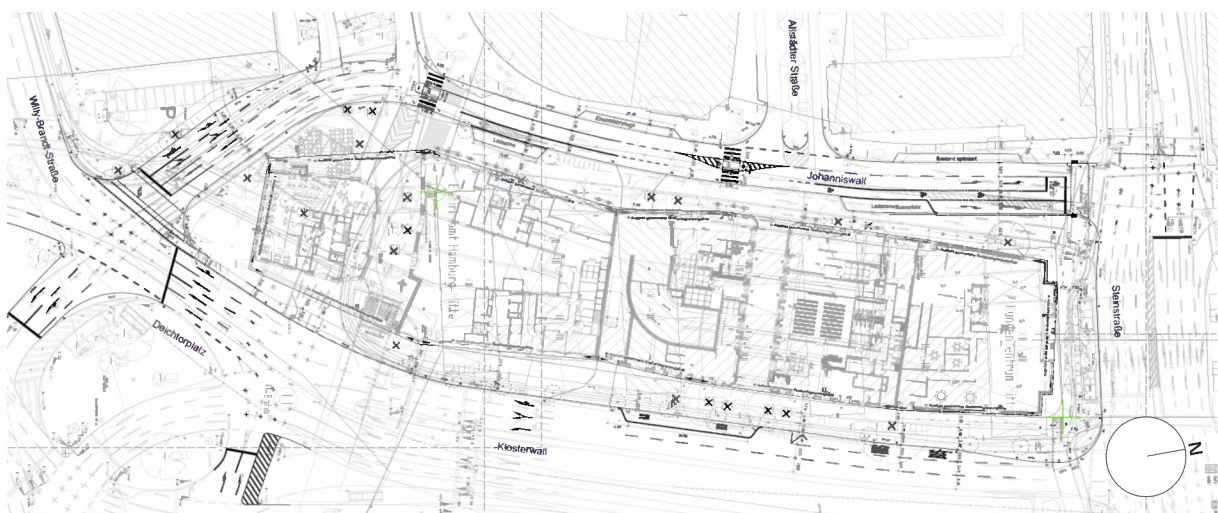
Lage und Erschließung des Bauvorhabens (eig. Darstellung, Planstand 14.06.2018)
